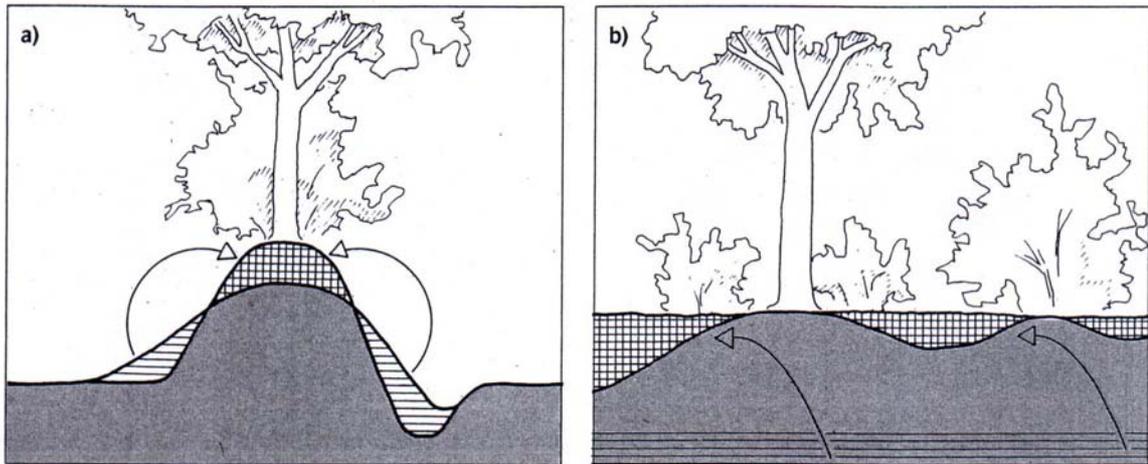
Instandsetzen eines Wallkörpers a) Querschnitt, b) Seitenansicht
